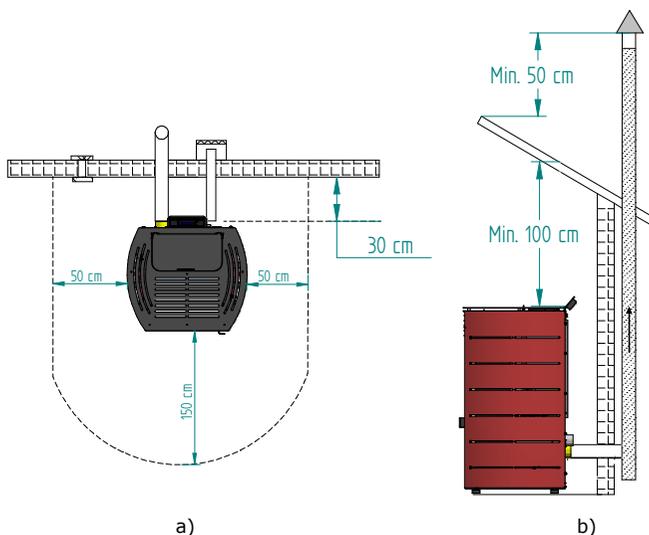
Distanze minime da tutte le superfici: a) vista dall'alto dell'installazione dell'apparecchio; b) vista laterale dell'installazione dell'apparecchio
